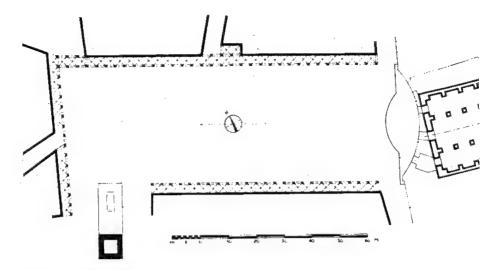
Vigevano, piazza Ducale, 1492-94: pianta originaria (ricostruzione da: Lotz, in Studi Bramanteschi, 1974).
